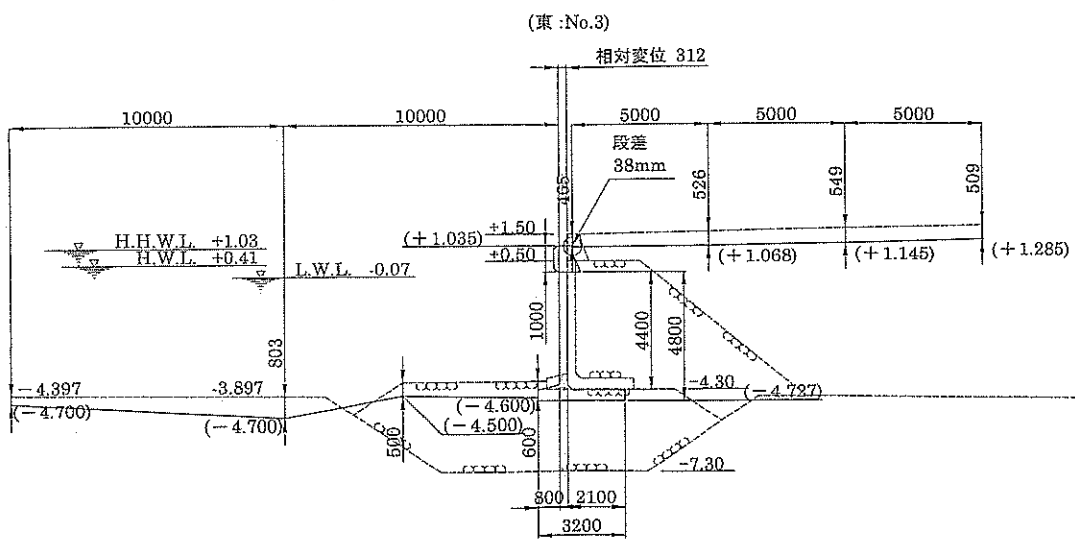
昭和中物揚場⑩ 標準断面図・被災変形図
